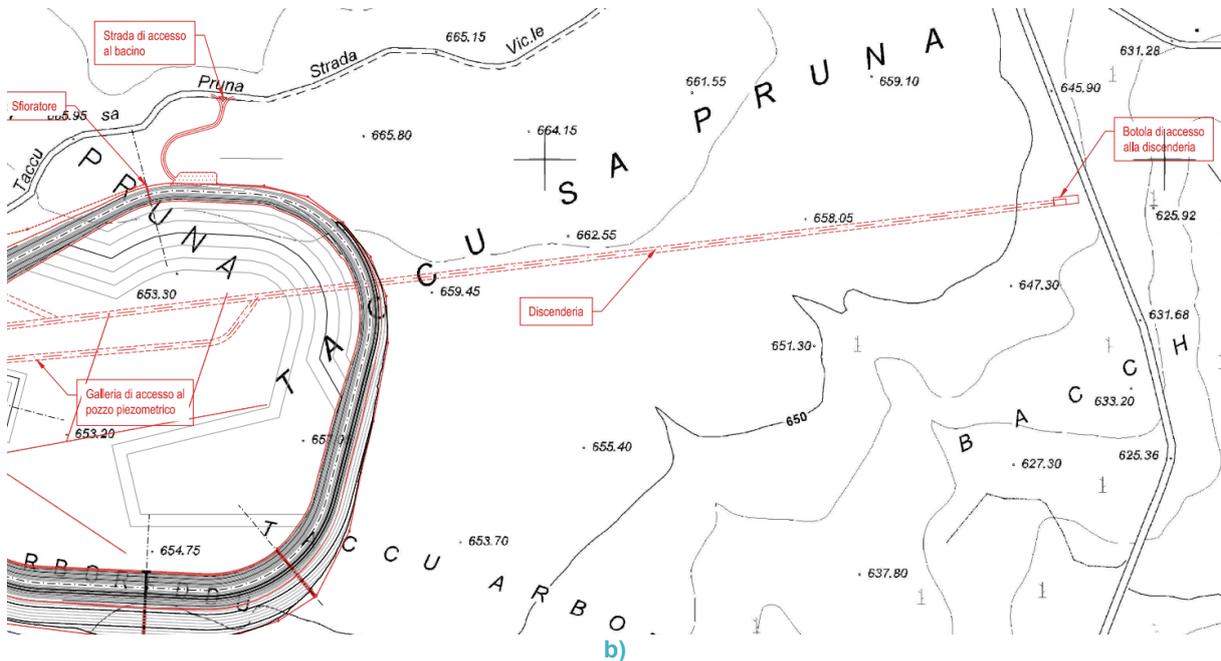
Stralci della Planimetria di Progetto su base CTR (1351-A-FN-D-01-1)
